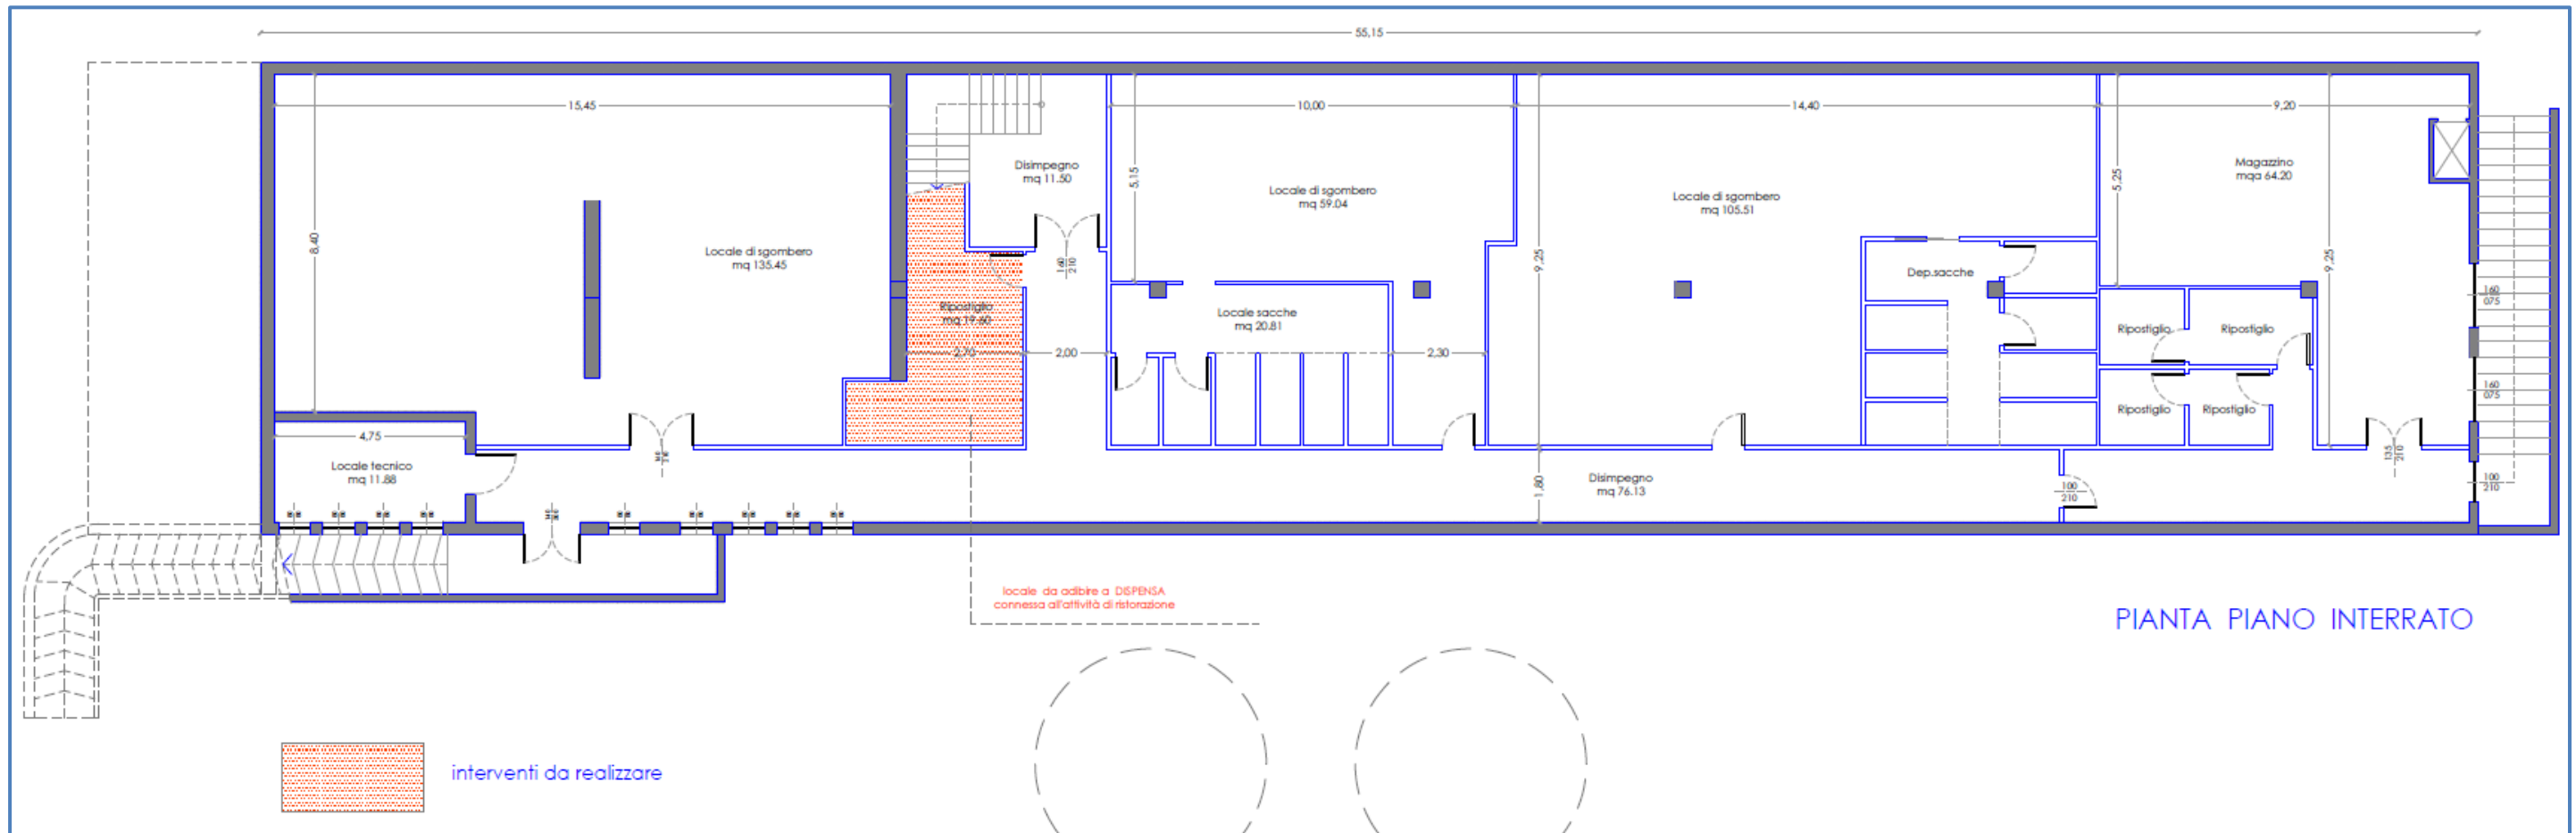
estratto della "Tav. n°1" del progetto allegato alla "pratica SUAP n°2474/2014"
